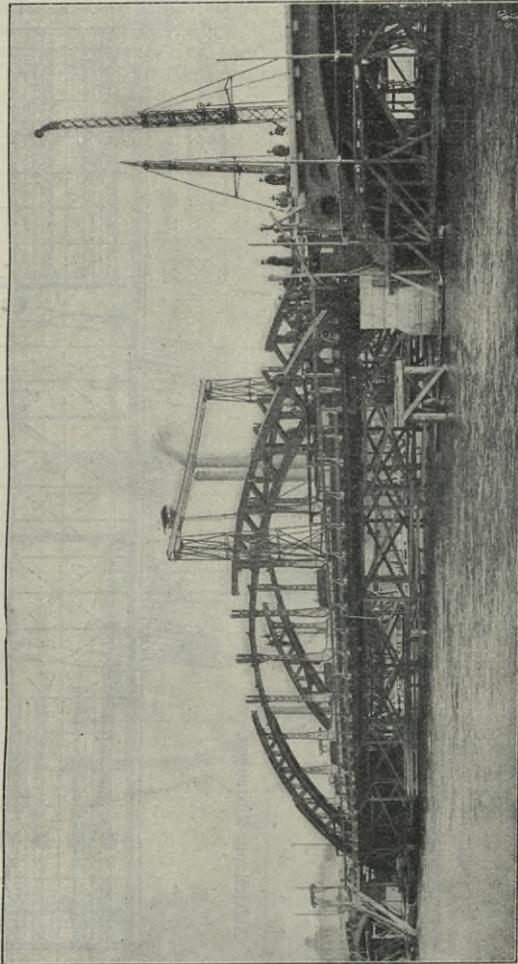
Montage der Mittelöffnung der Stubenrauch-Brücke bei Berlin. D. B. Z. 1908, S. 472.
